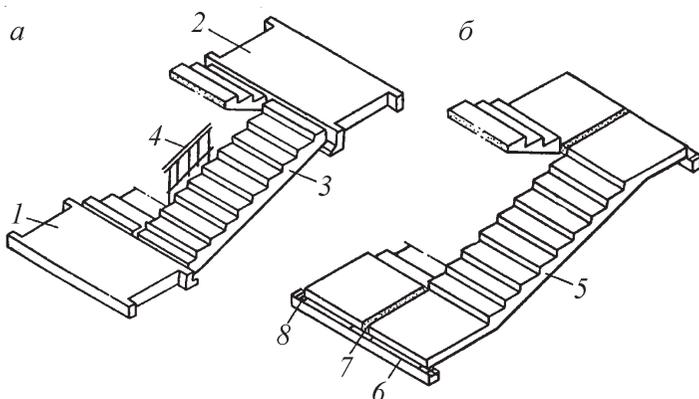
Двухмаршевые лестницы из крупноразмерных элементов: *а* – из площадок и маршей; *б* – из маршей с двумя полуплощадками; 1 – площадка этажная; 2 – то же, промежуточная; 3 – марш; 4 – ограждение; 5 – марш с двумя полуплощадками; 6 – ригель; 7 – заделка бетоном; 8 – закладные детали
